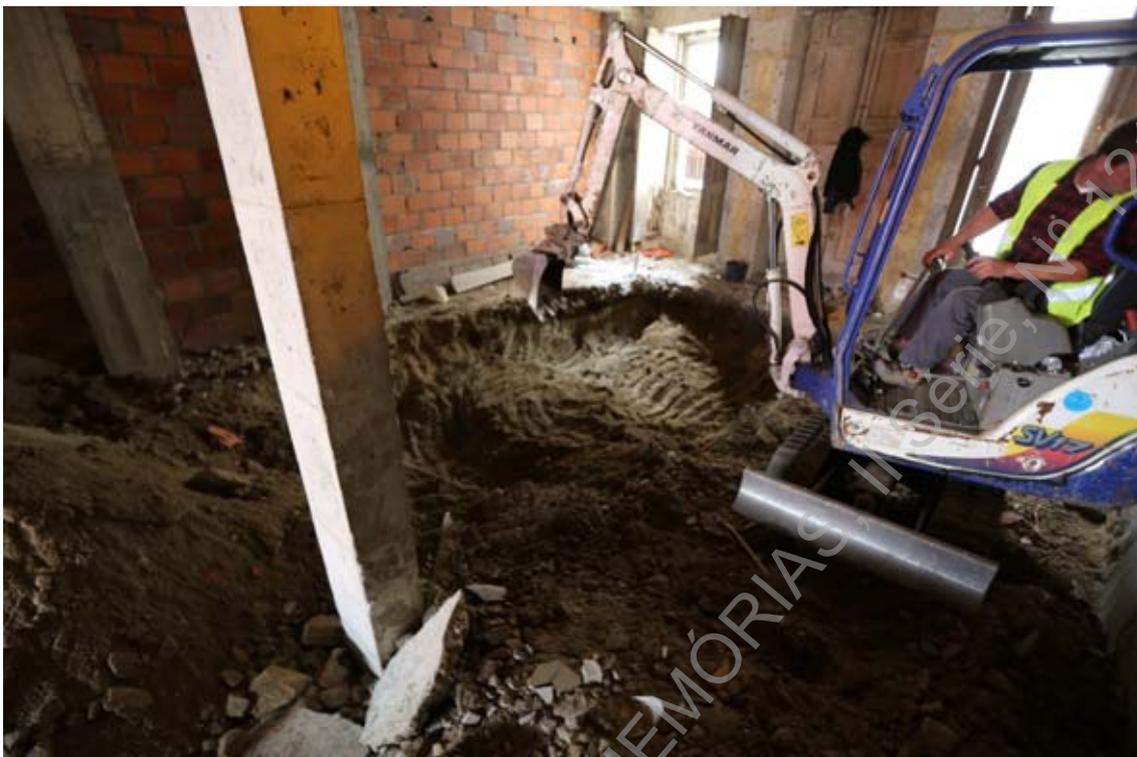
(Z45A2960) – Acompanhamento do desaterro da sondagem 1.
